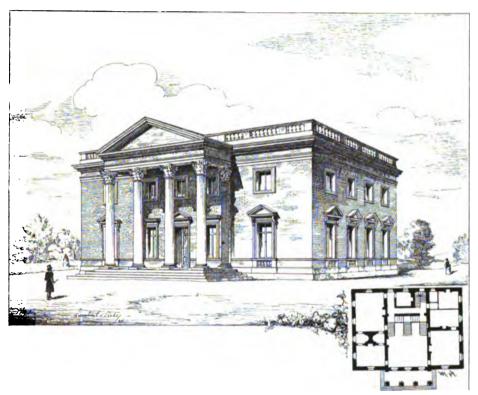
Abercornhouse zu Duddingstone. Ansicht und Grundriss.
